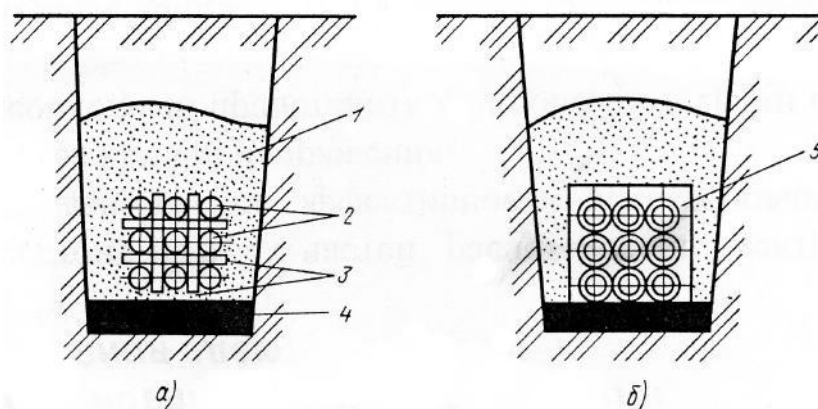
Кабельный блок из асбоцементных труб в сухих (а) и влажных (б) грунтах: 1 – песок или просеянный грунт, 2 – трубы, 3 – деревянные прокладки, 4 – бетонная подушка, 5 – гидроизоляция
